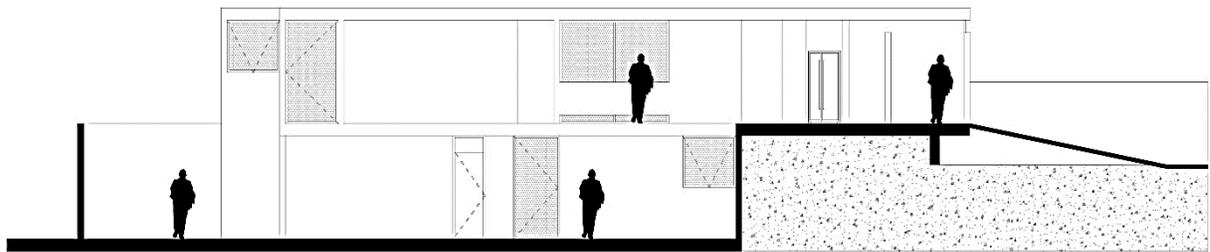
3D de planta baja y planta alta donde se puede observar parte del funcionamiento interno, así como la topografía del terreno.
